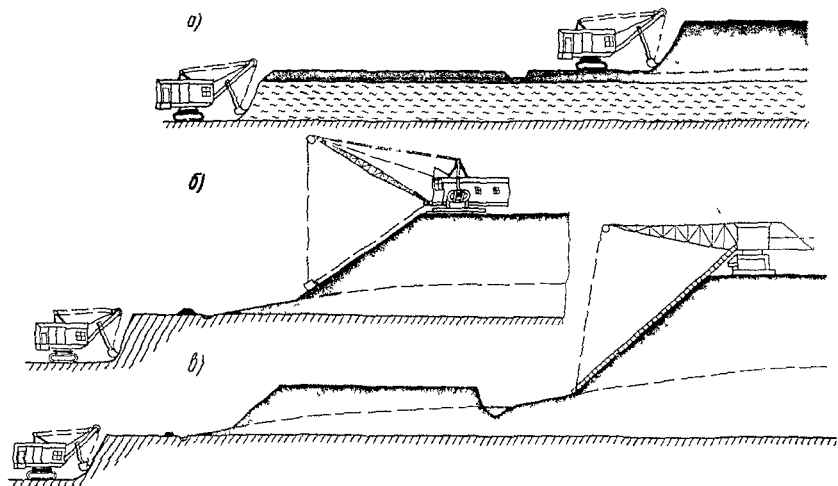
Схемы открытого дренажа песчаных грунтов на рабочем борту
